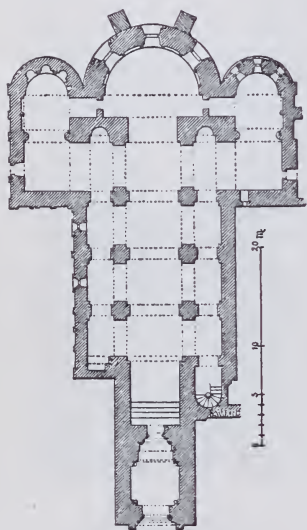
Grundriss von S. Guillem-du-Désert.
